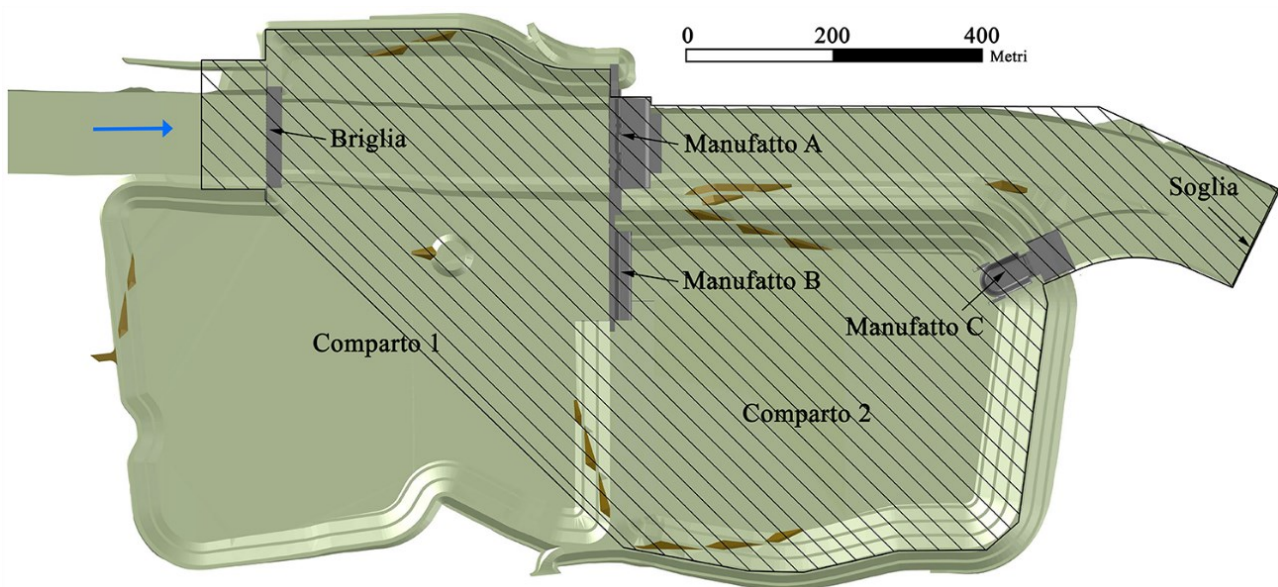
Pianta della cassa d'espansione. La porzione campita a tratteggio costituisce l'area oggetto di modellazione.
